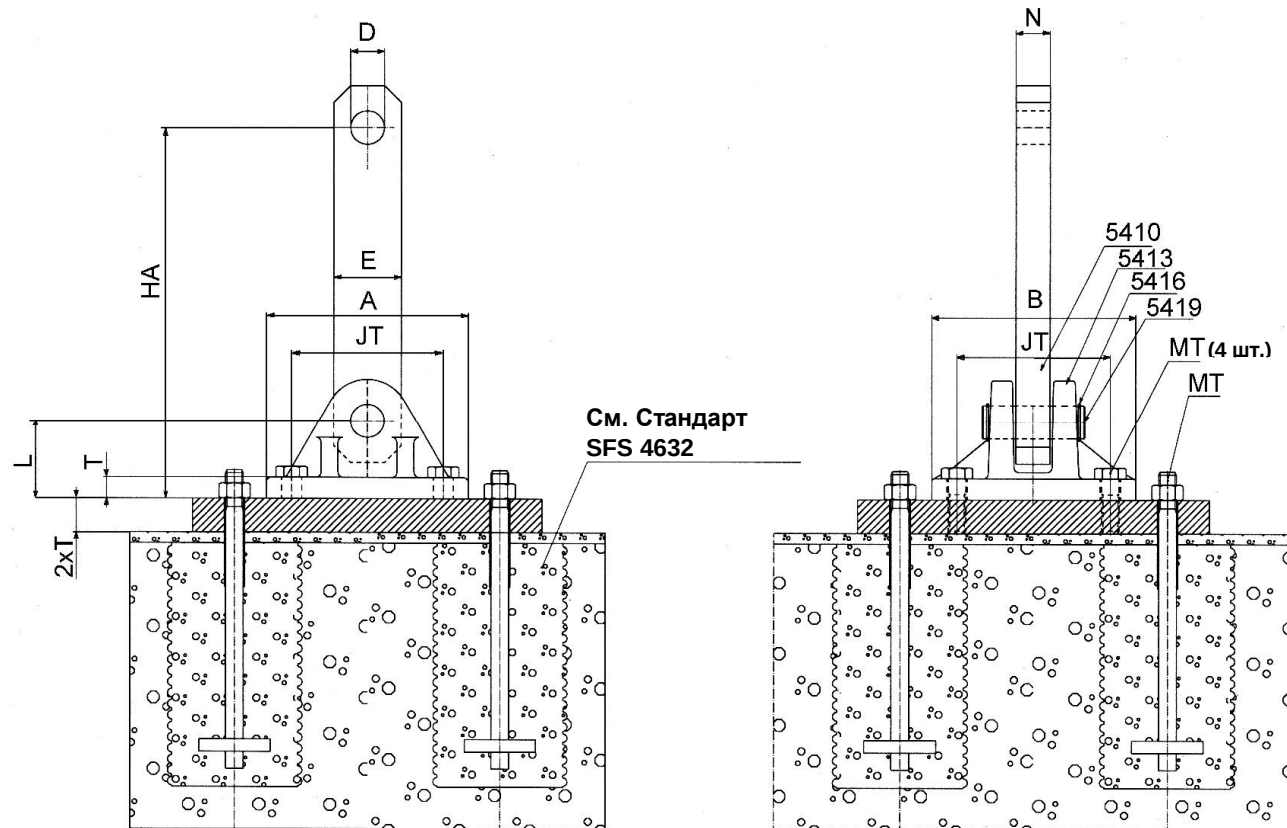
Детали и размеры реактивной штанги, размеры 50-90
